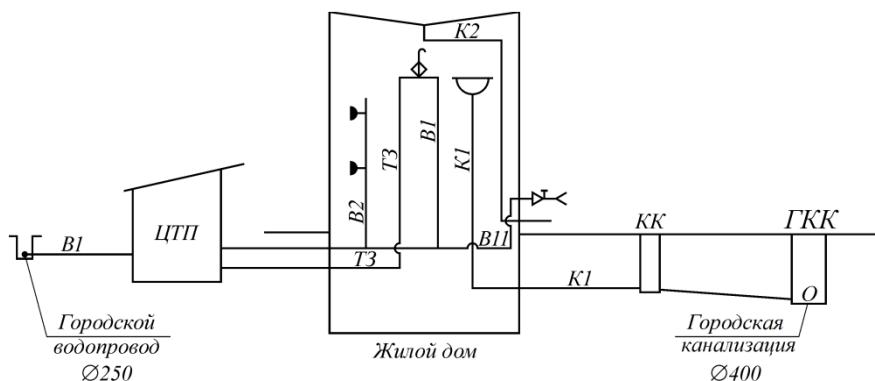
Схема водоснабжения и водоотведения жилого дома
